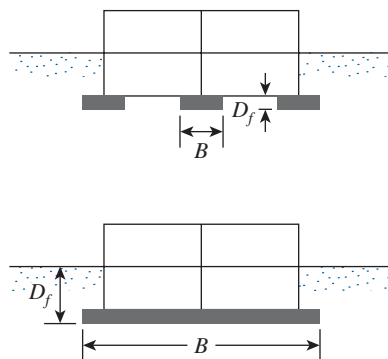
Comparación de una cimentación aislada y una losa de cimentación (B = ancho, D_f = profundidad).
